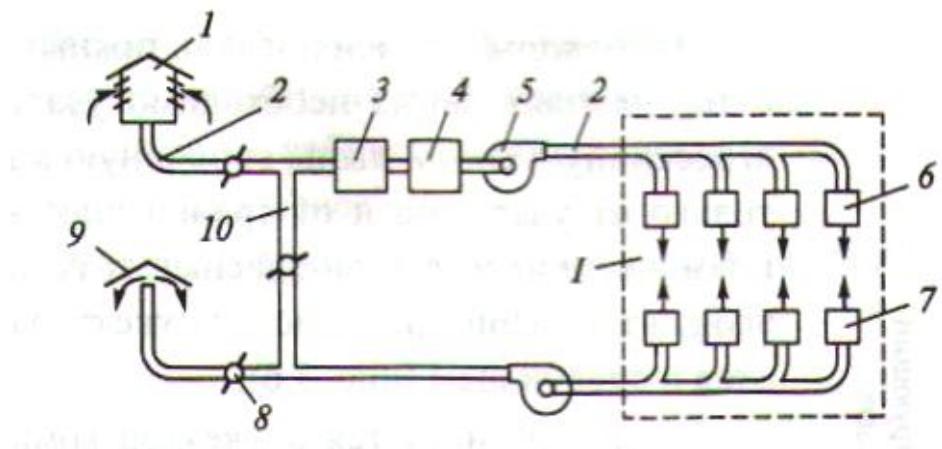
Схема приточно-вытяжной механической вентиляции:
